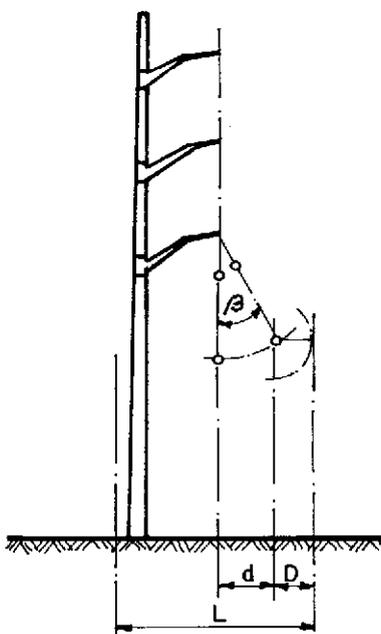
Faixa de servidão – condutores dispostos verticalmente
